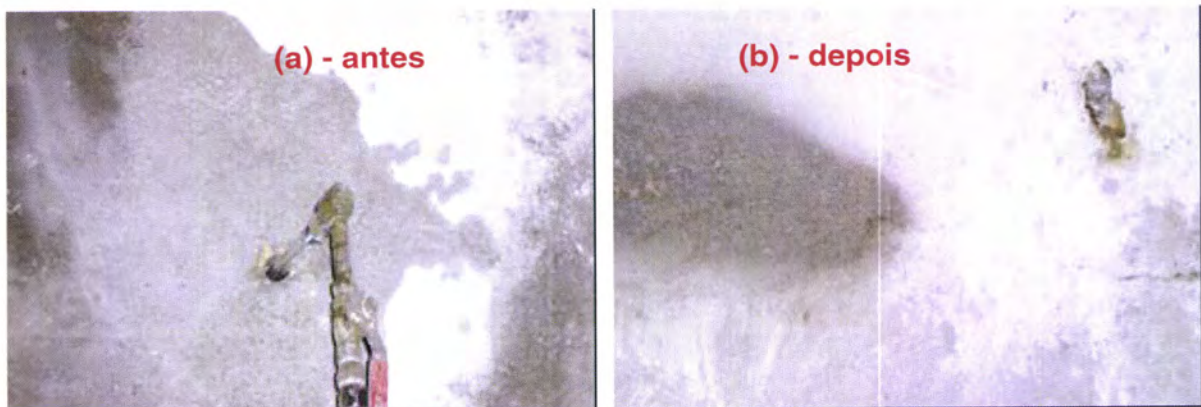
(a), (b) – Aplicação do prepolímero sintetizado no pavimento
